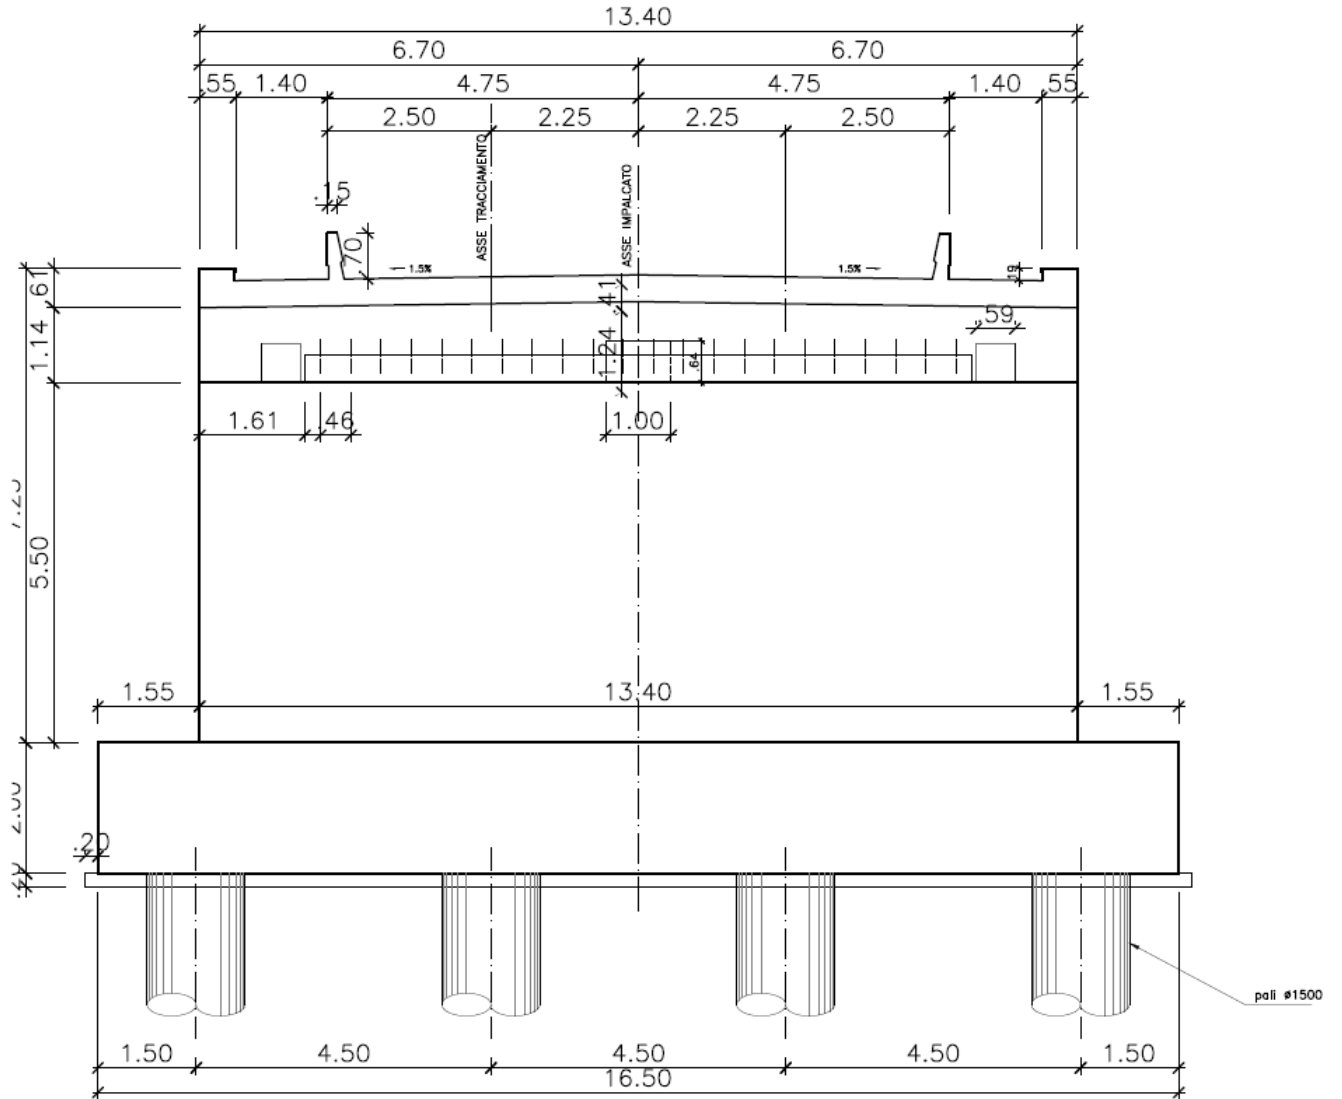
Prospetto frontale Spalla "A".
